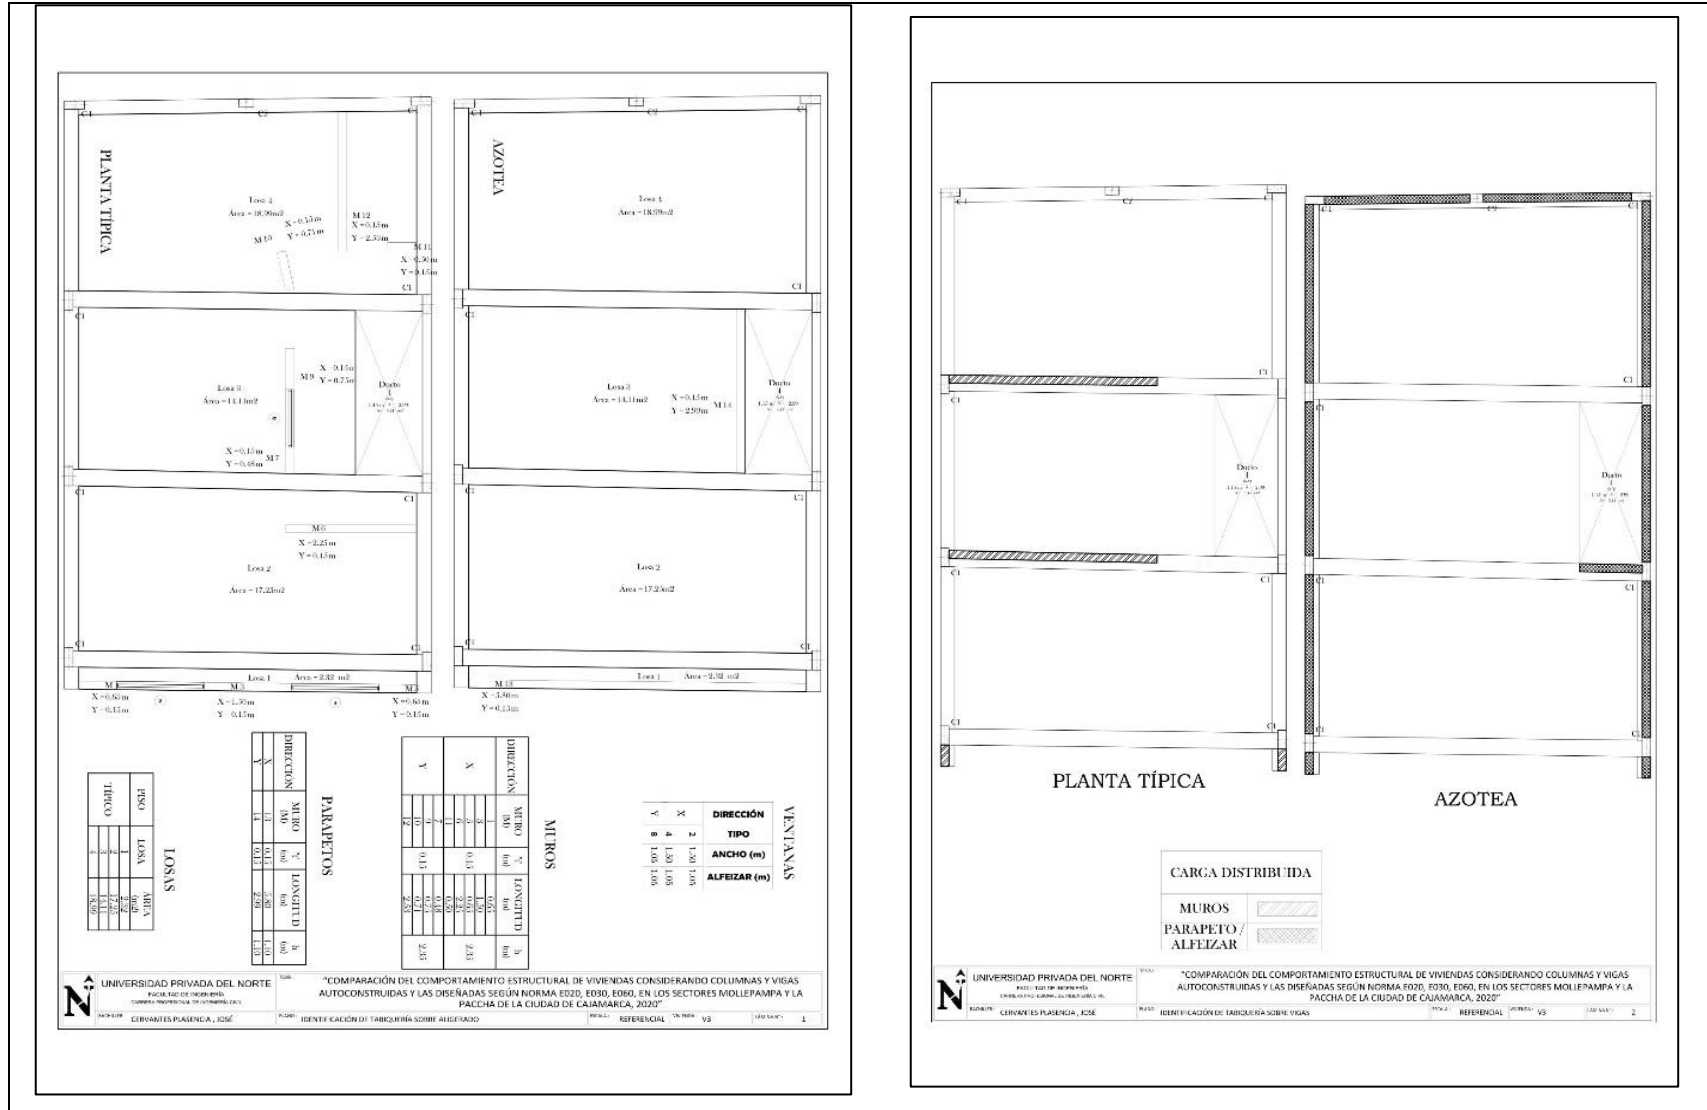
Tabiquería sobre losa aligerada y vigas vivienda 4
